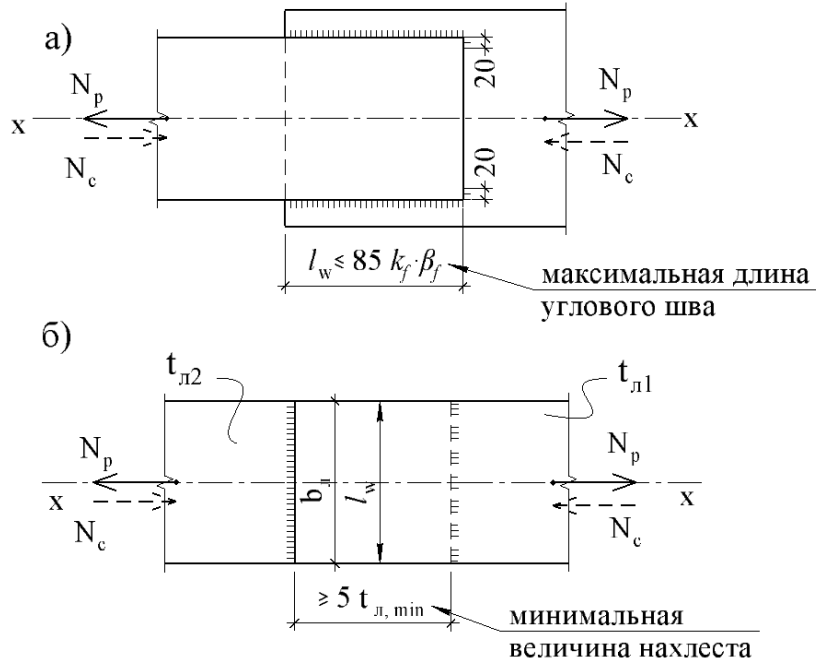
Схема сварных соединений на угловых швах, нагруженных центральной силой N_p (N_c):
